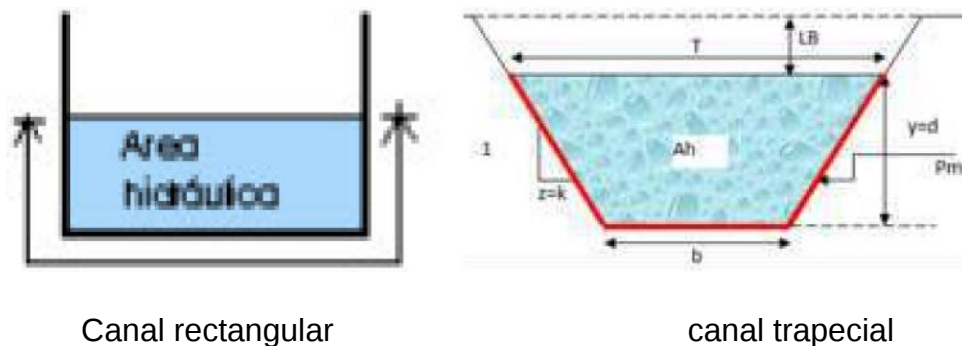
Área hidráulica y perímetro mojado en canales abiertos
